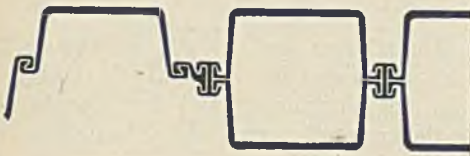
Anschluss gewöhnlicher Larssenwände an das Kastenprofil. (Dortm. Union, Deutsche Stahlwerke.)
